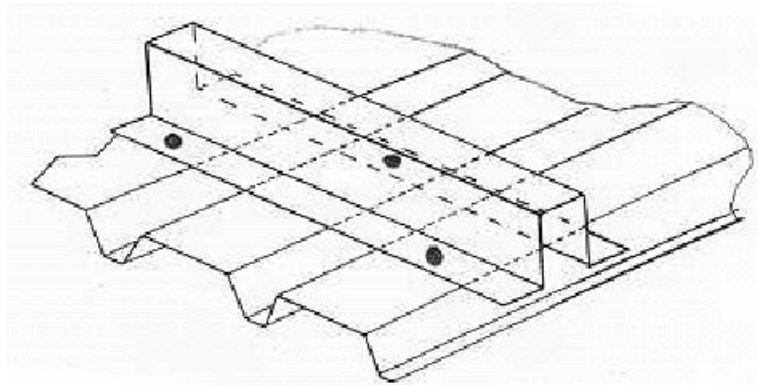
Fixation en alternance d'une fausse panne sur un profil HACIERO
